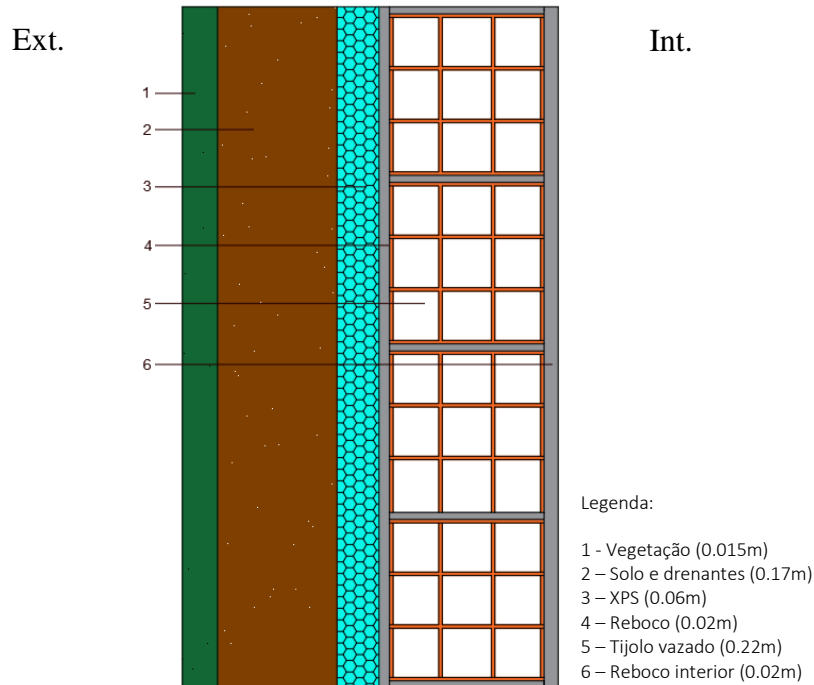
Pormenor construtivo referente à solução construtiva jardim vertical
